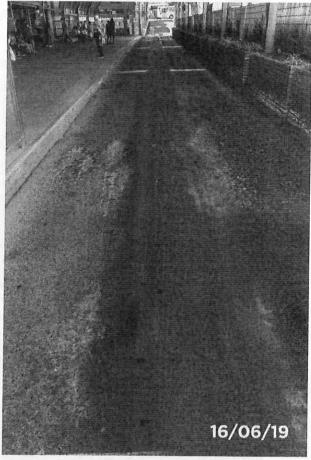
Vista da fissura no pavimento asfáltico com pequenos buracos, ondulações, infiltração causada pelo jardim do terminal rodoviário.
